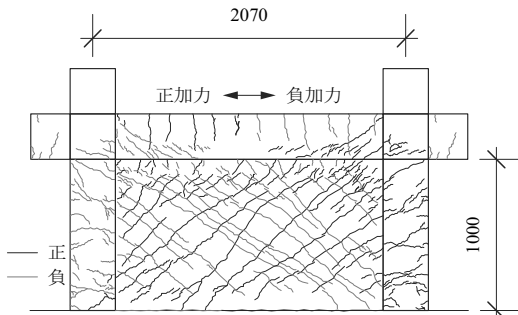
最終ひび割れ発生状況のスケッチ
